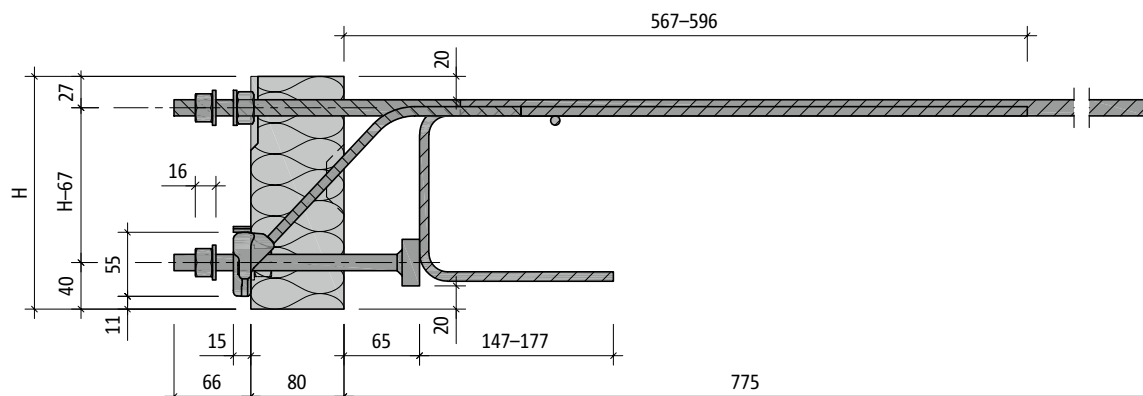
Schöck Isokorb® T type SK-M1-V1 : vue en coupe du produit
